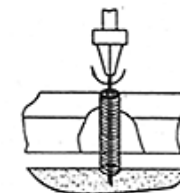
Высверлите отверстие в бетоне через болт-стойку
